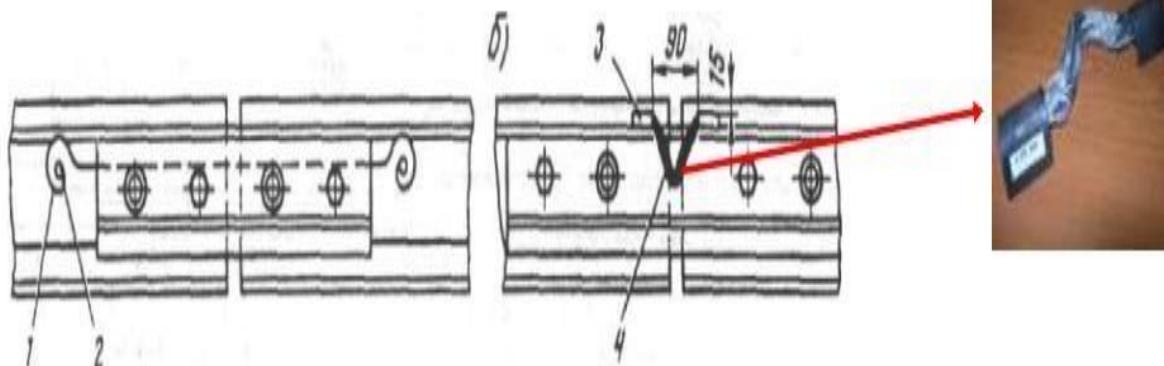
Рельсовые соединители: а) штепельный; б) приварной;
